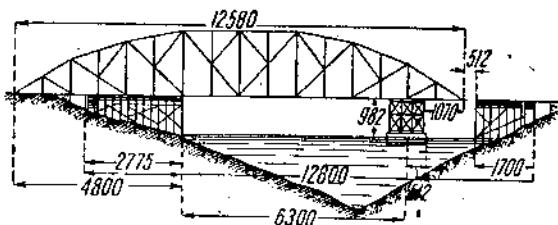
Продольная надвигка помощью отдельных промежуточных опор
